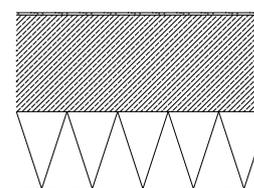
Aufbau Stahlbetonkonstruktion mit WDVS
